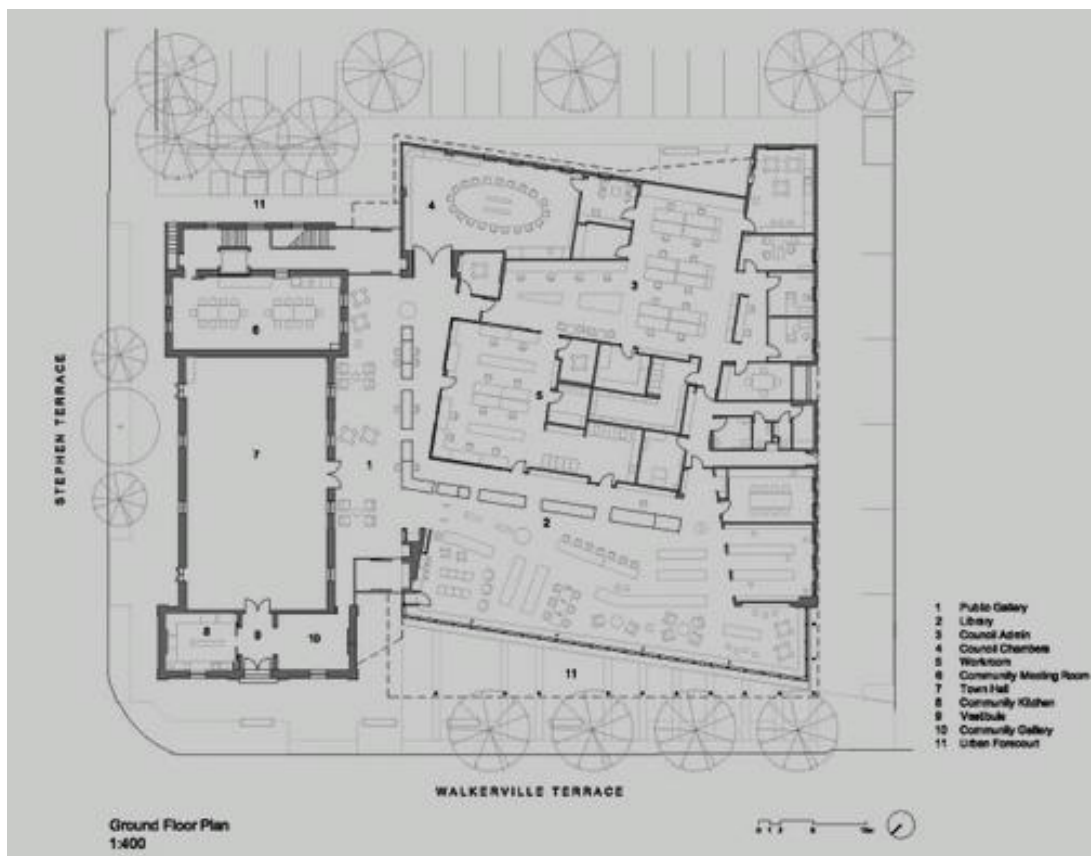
Planta general del Centro Cívico y Comunitario de Walkerville
